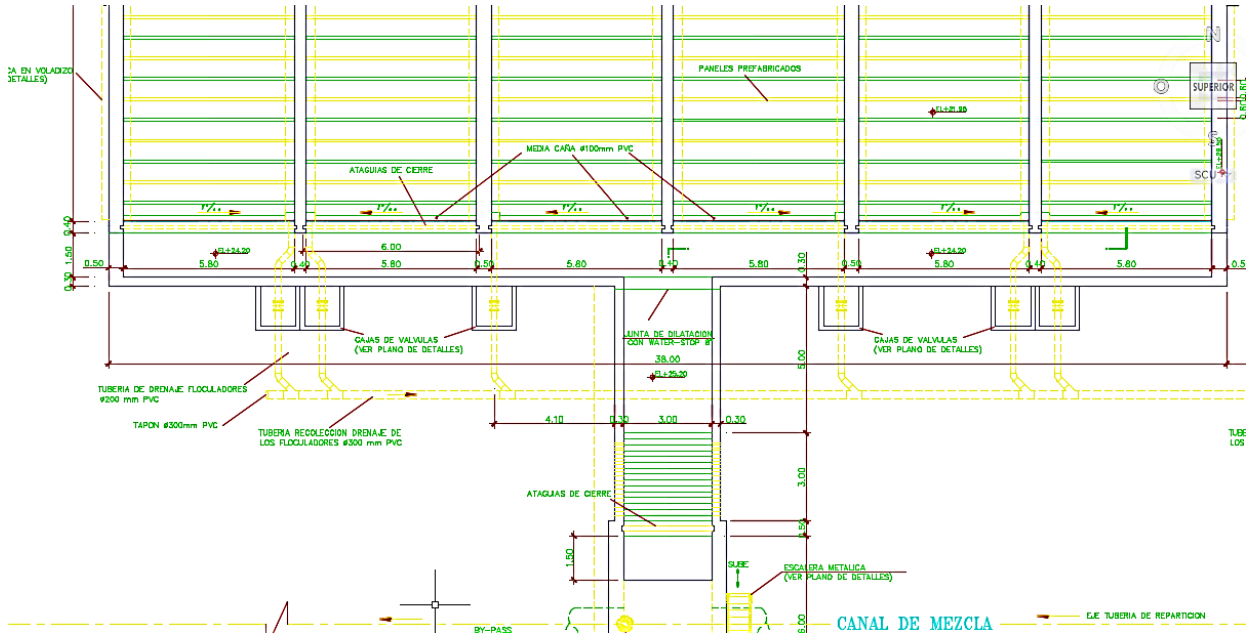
Vista en planta de canal de entrada a los floculadores de la P.T.A.P de Barrera de Salinidad
